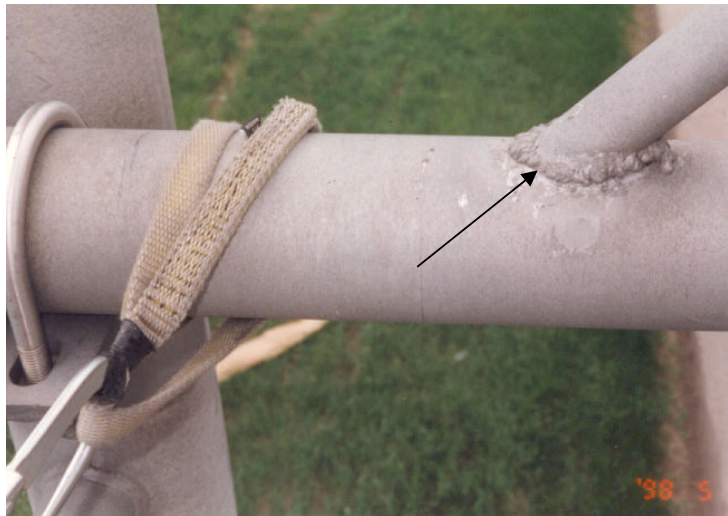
Évaluation du comportement des assemblages soudés
